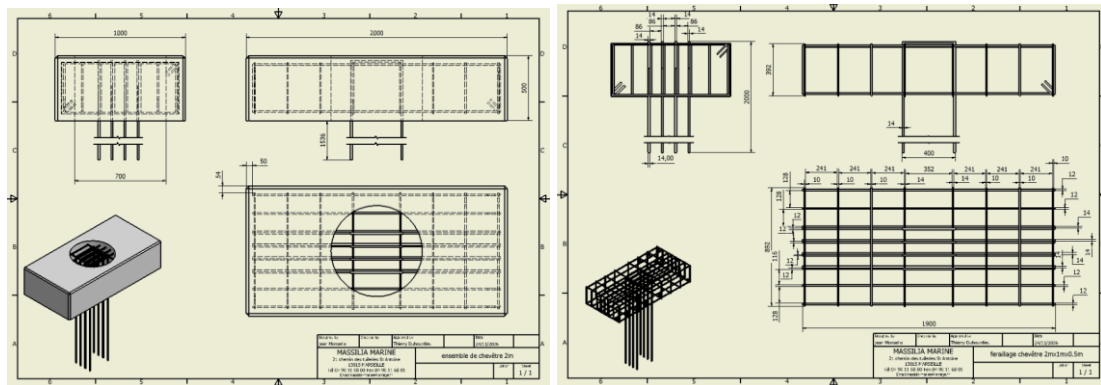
Plans de coffrage et de ferrailage des chevêtres des pontons fixes
